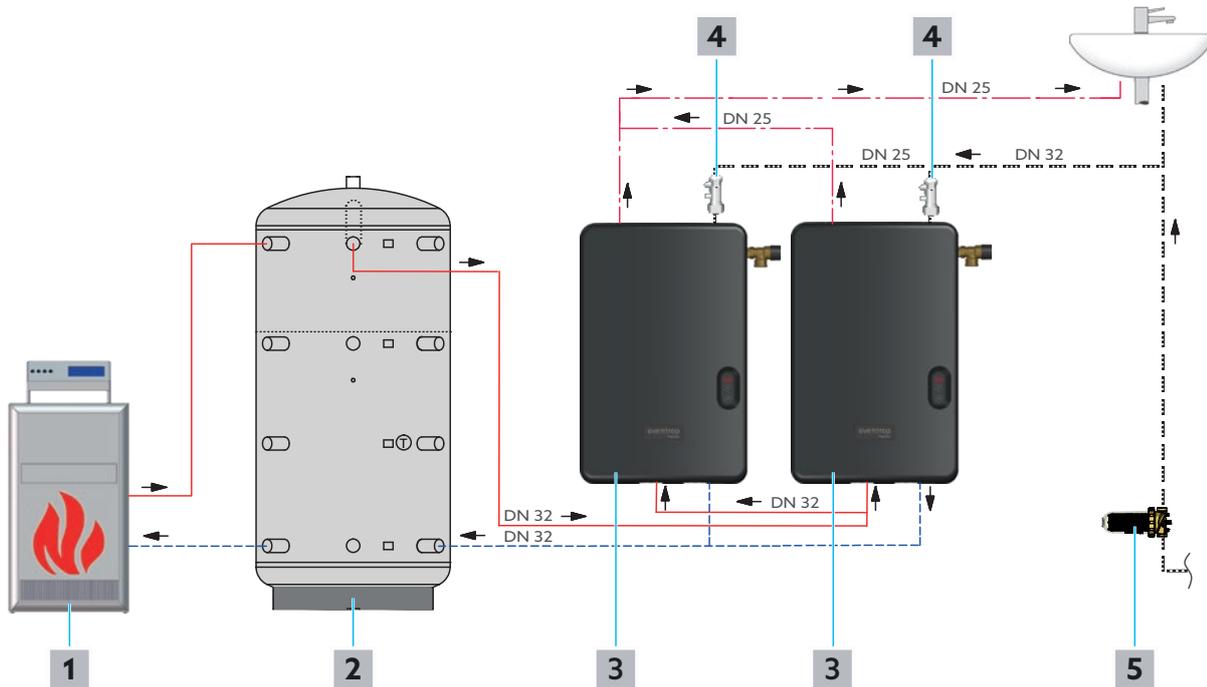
Schéma d'installation avec un ballon d'eau chaude et deux stations d'eau chaude sanitaire
